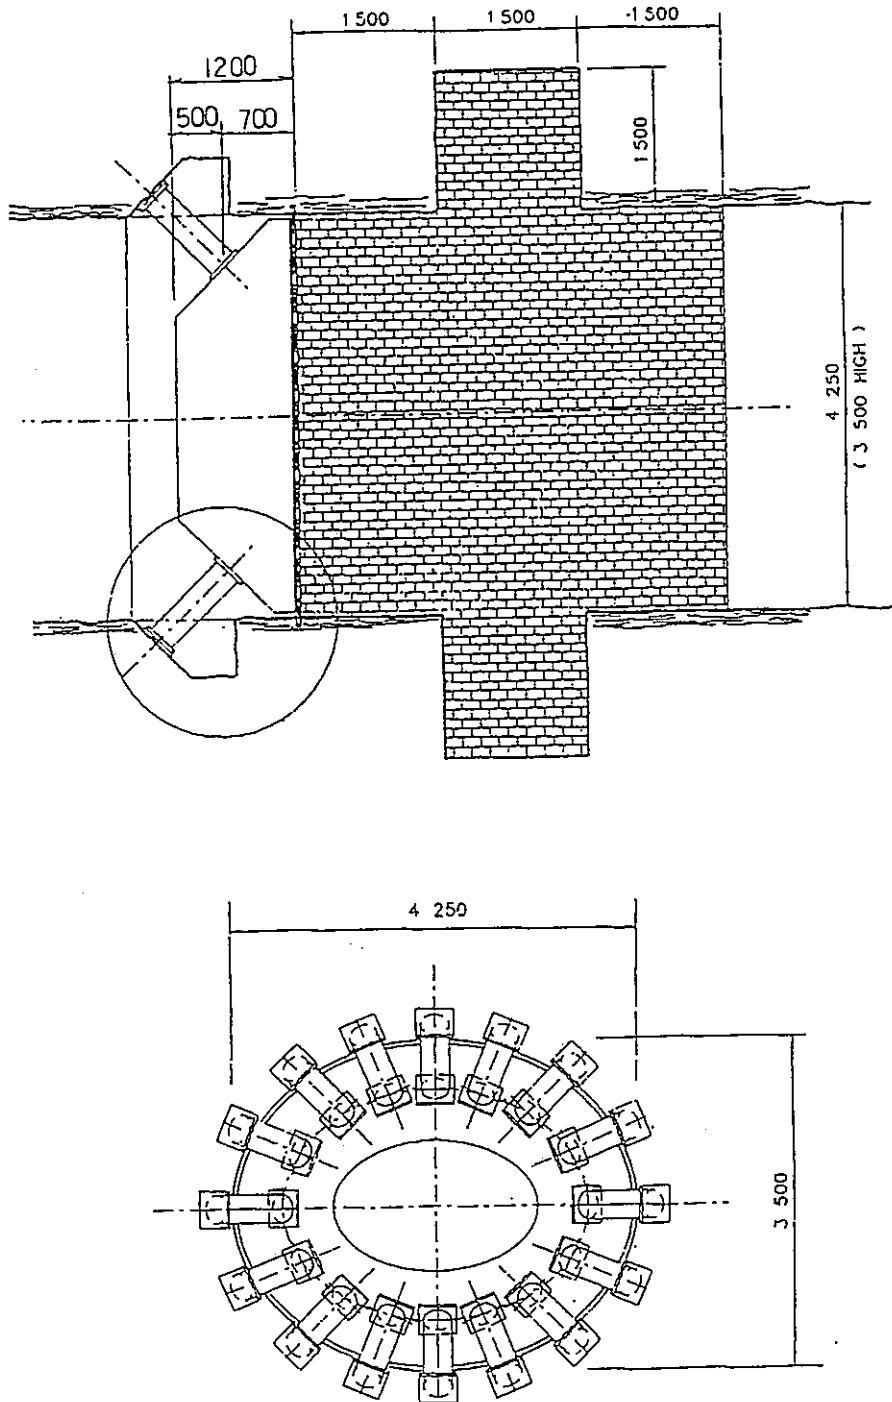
「無筋コンクリート製隔壁－鋼製支柱」工法の概要
